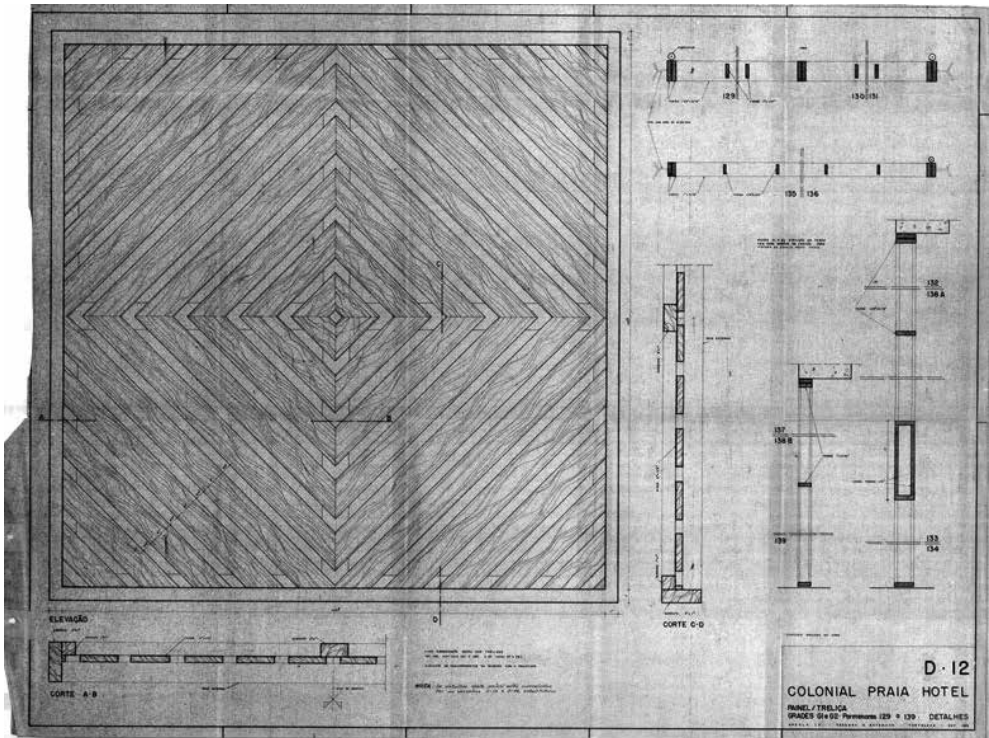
Hotel Colonial. Detalhe Construtivo. Projeto original.
